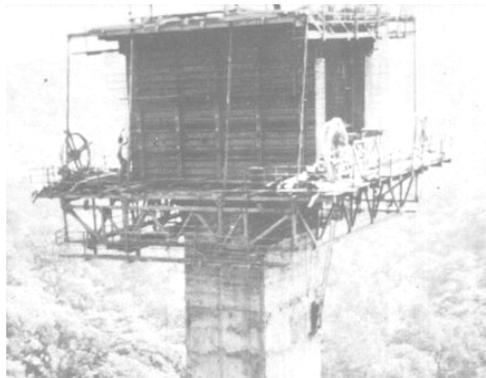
Cimbrado de la dovela de pila, puente Metlac.
